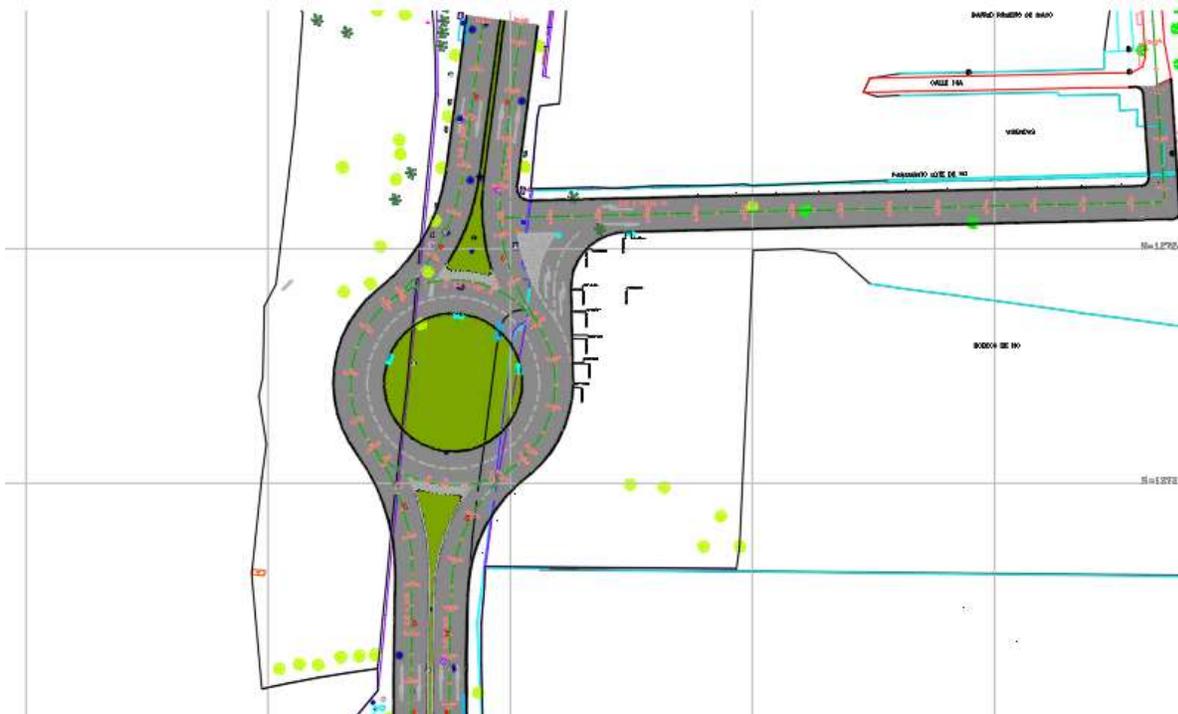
Plano de la rotonda de la cr 26 calle 14
